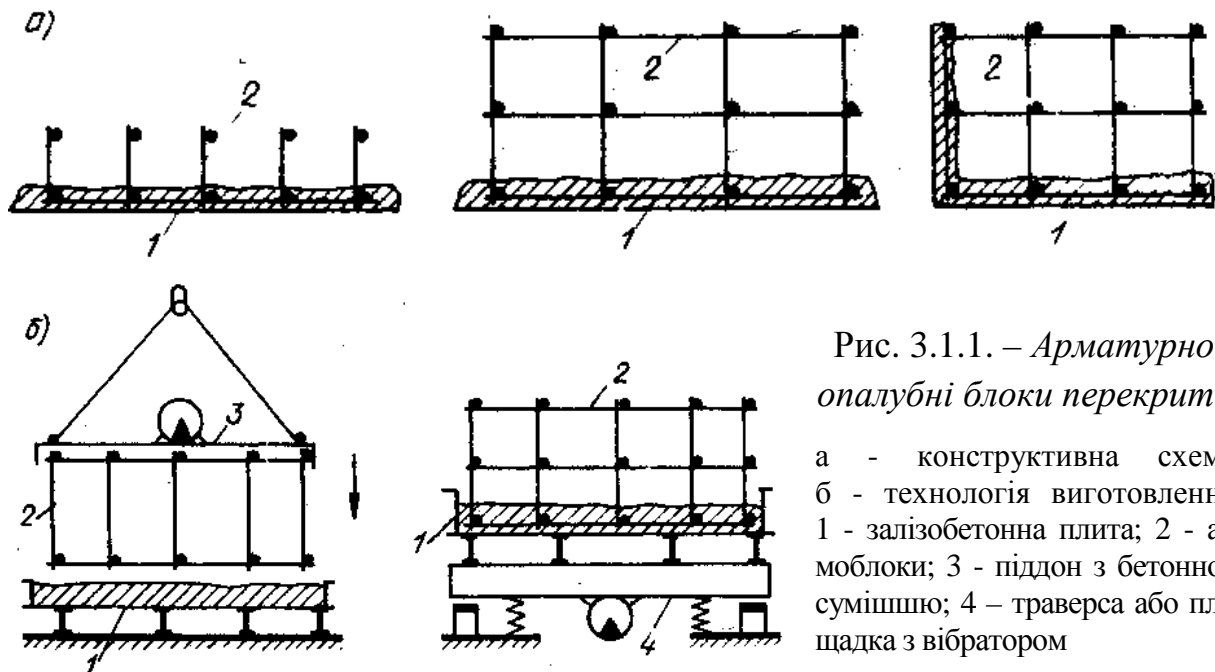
Арматурно-опалубні блоки перекритть:
